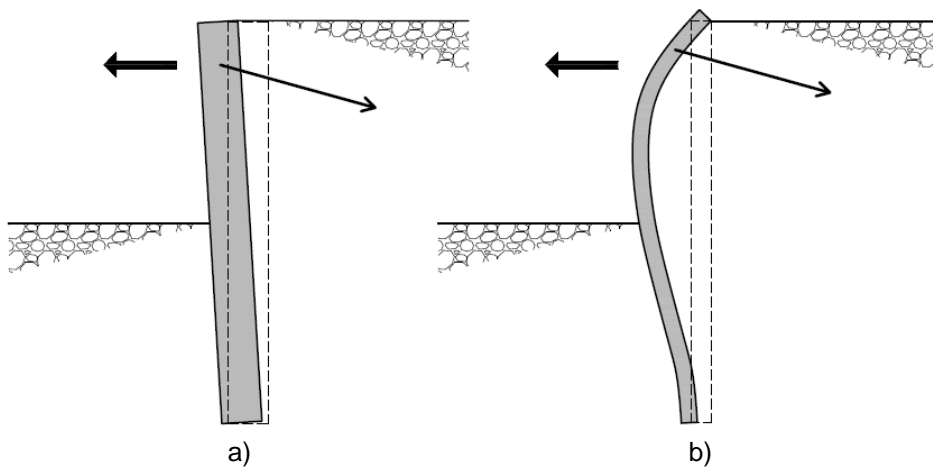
Tipos de estruturas de contenção – a) Estrutura perfeitamente rígida – b) Estrutura flexível.
